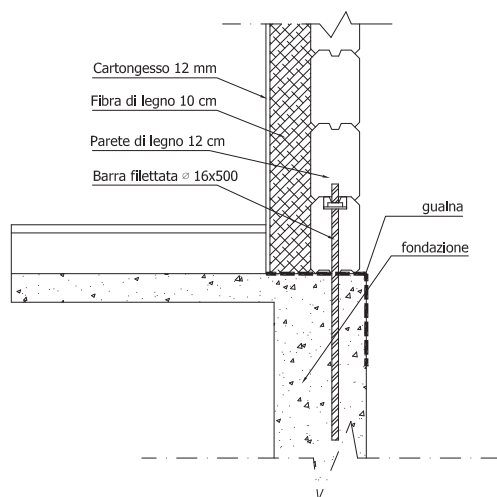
Collegamento alle fondazioni per un edificio Log House con tirafondi metallici ancorati al calcestruzzo con malta cementizia o epossidica.
